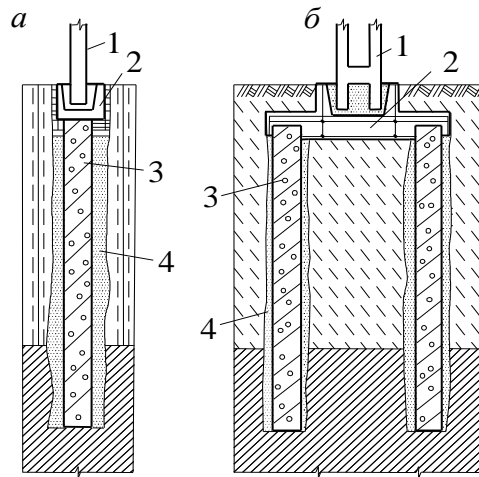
Конструкції збірних шліцьових фундаментів із плоских панелей: а – однорядний; б – дворядний; 1 – колона; 2 – ростверк зі стаканом під колону; 3 – збірний плоский елемент; 4 – тампонажний розчин
